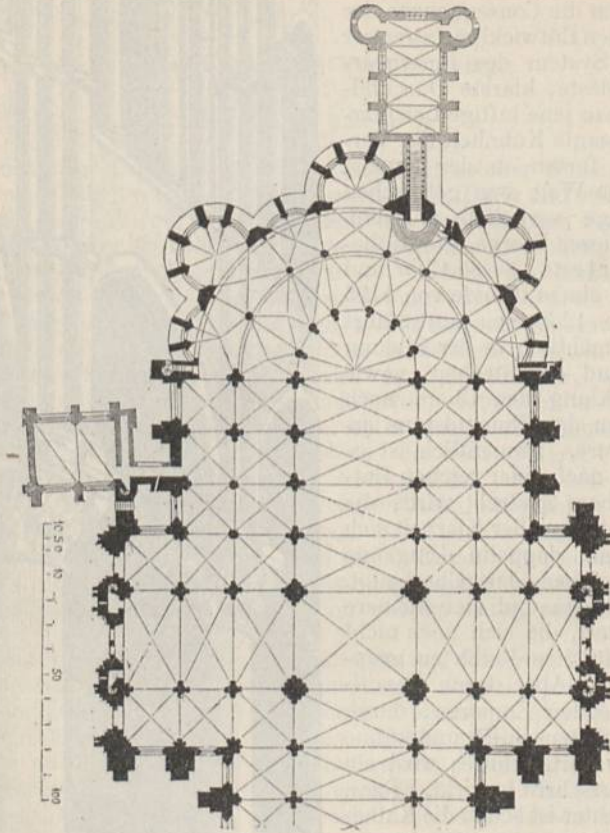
Chor der Kathedrale zu Chartres. Grundriss.
